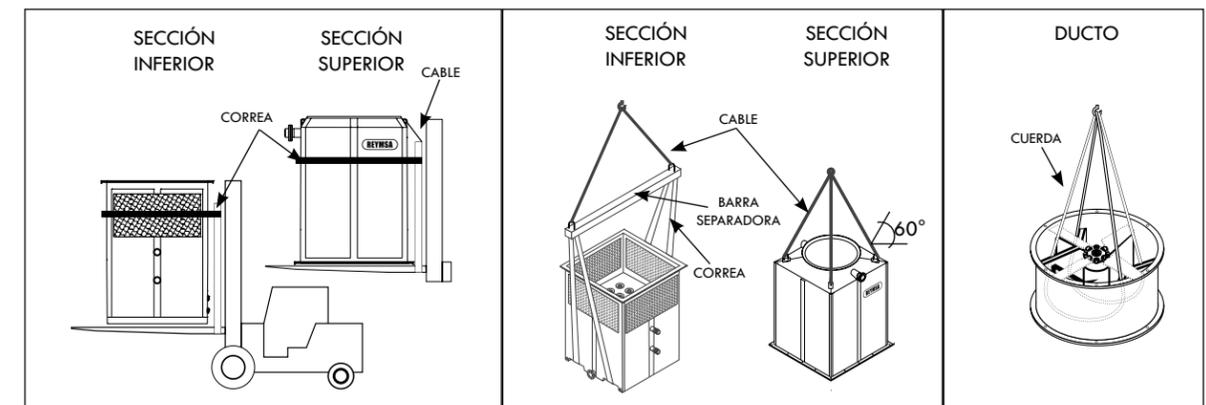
Levantamiento con montacargas de una torre de un ventilador
